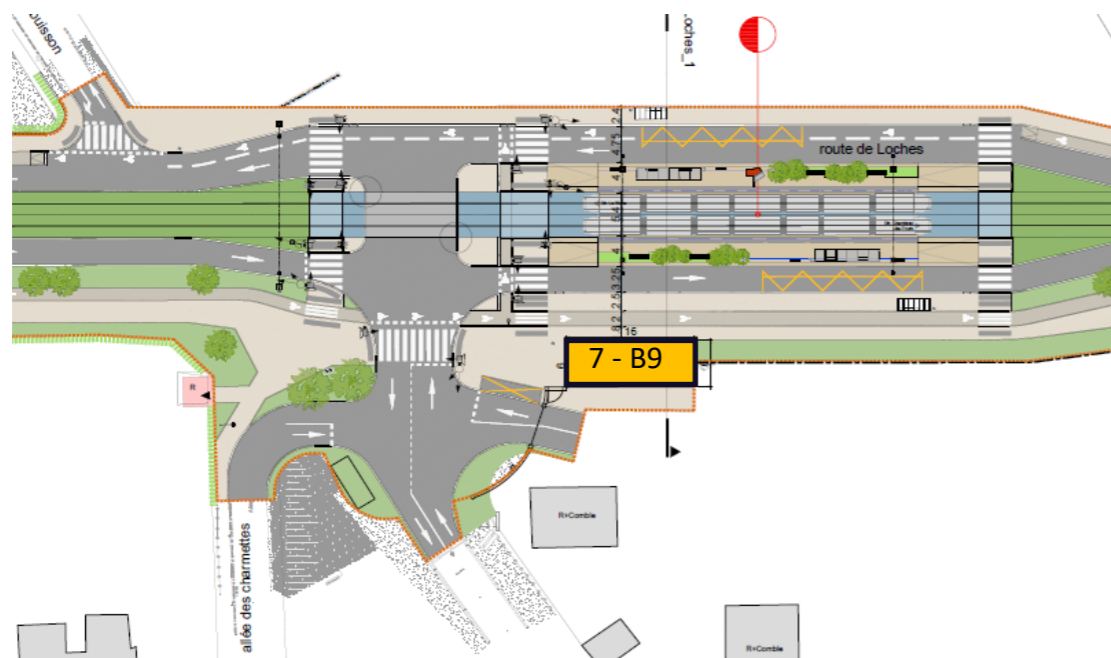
plan de localisation provisoire la station SSR 7-B9
